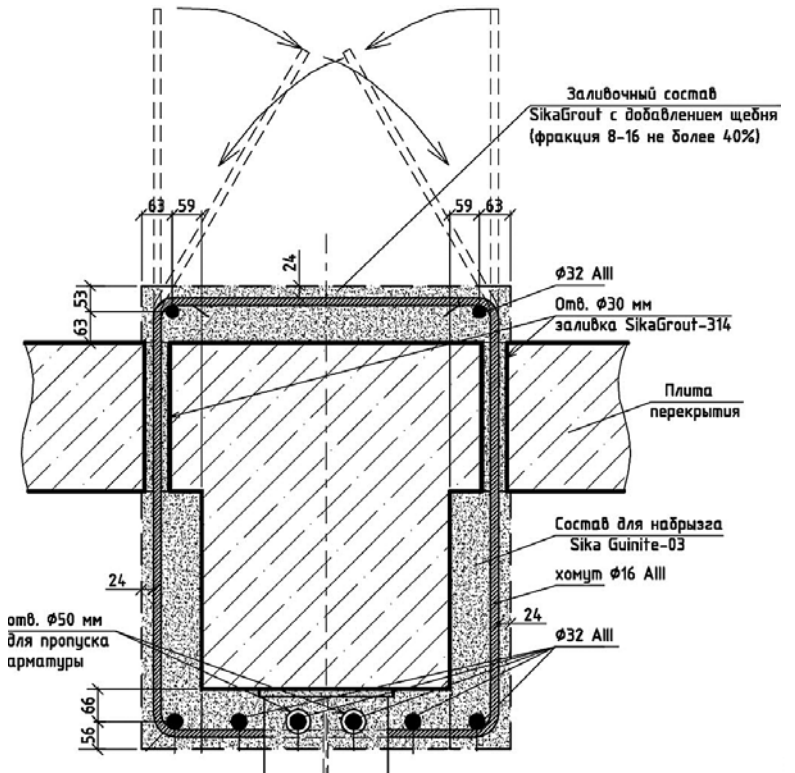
Этапы усиления аварийных монолитных балок железобетонной обоймой
